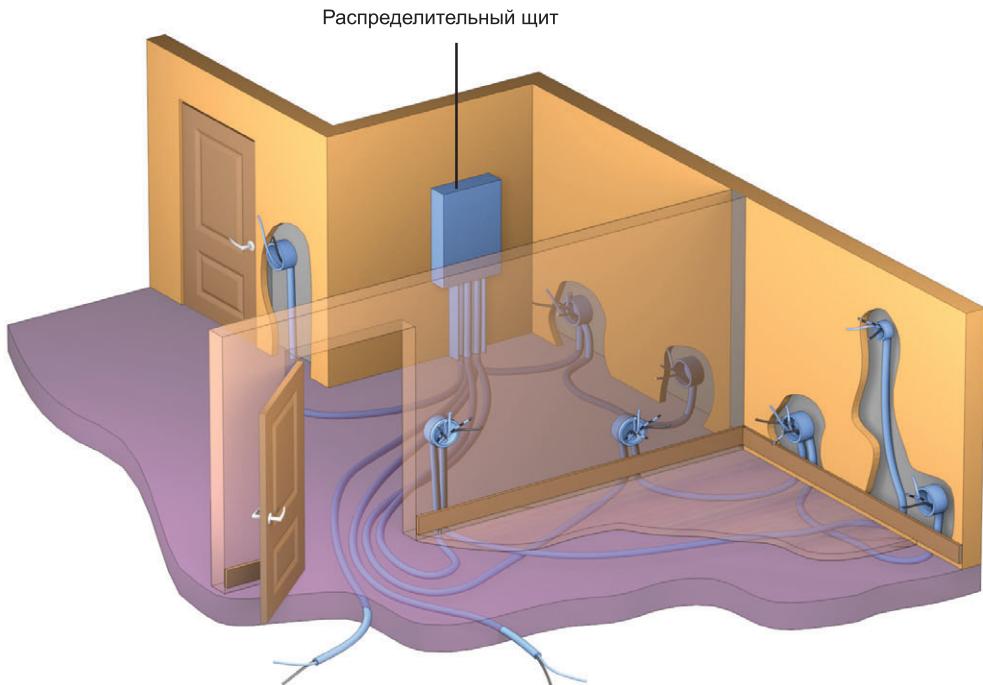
Вариант скрытой прокладки: проводка вмурена в бетонную стяжку
